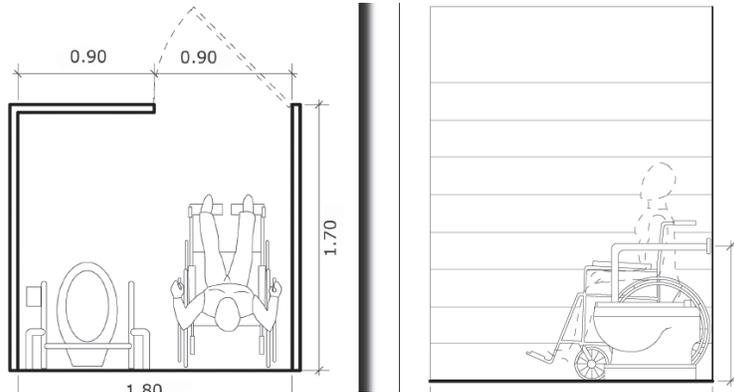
Planta y elevación inodoro público, CONADI, 116.
